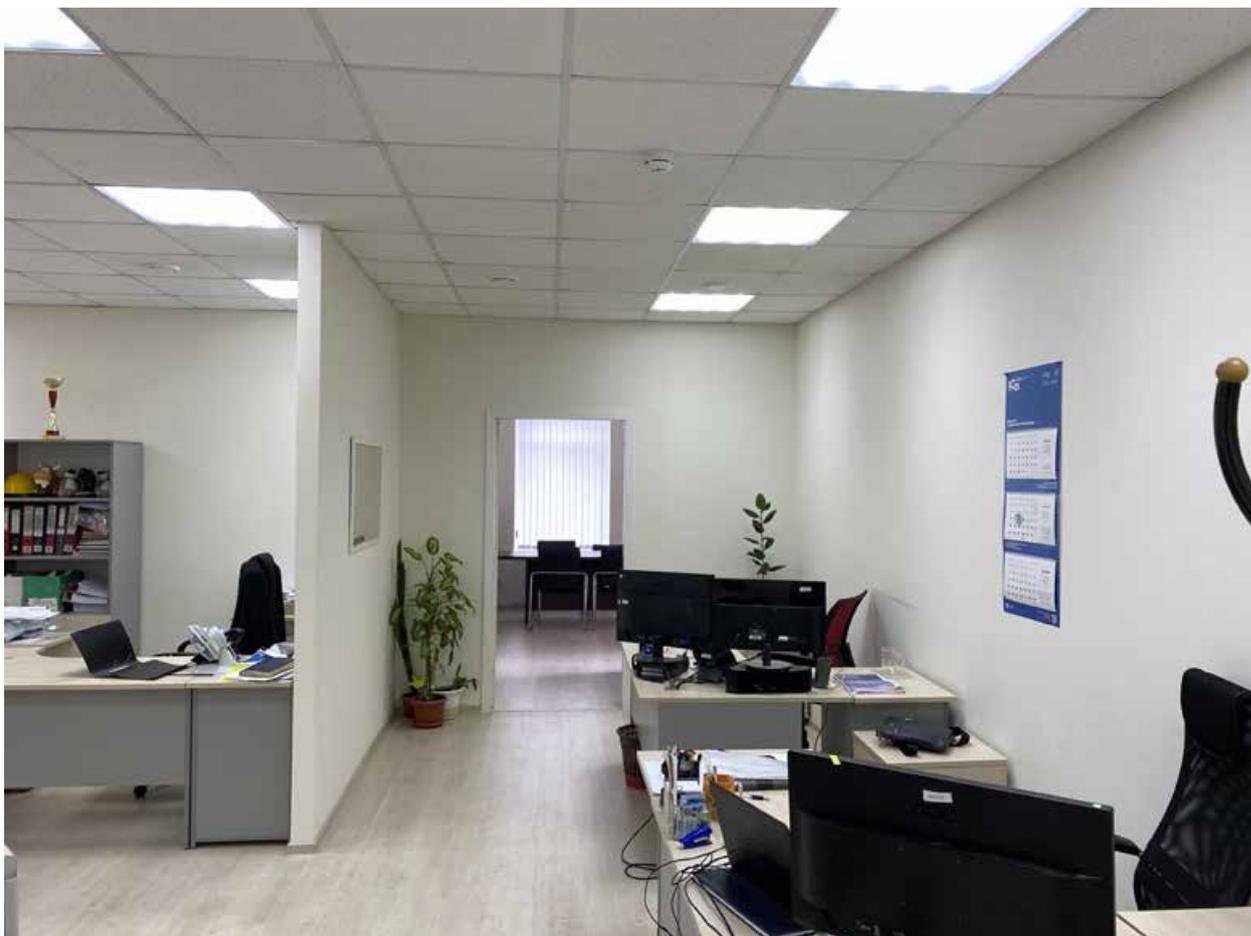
3 этаж. Помещение 6-Н(16-20).
